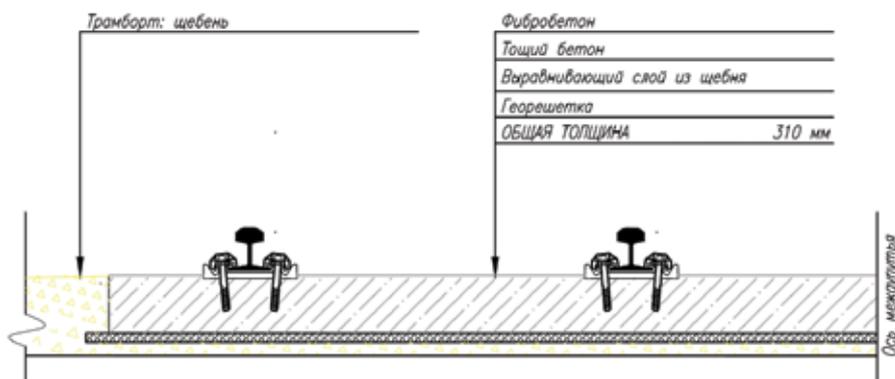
Конструкция на монолитном основании из фибробетона со скреплением типа Vossloh W-Tram и рельсами Р-65
